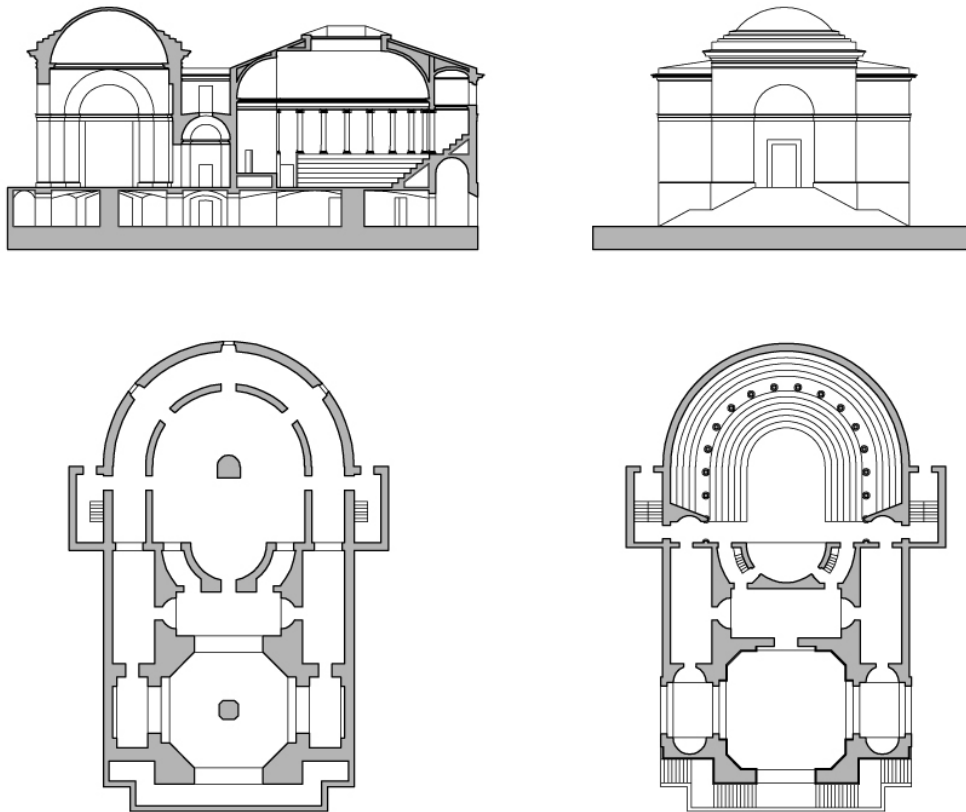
La sala della pubblica istruzione. La sezione, il prospetto, la pianta del piano terra e del piano rialzato
